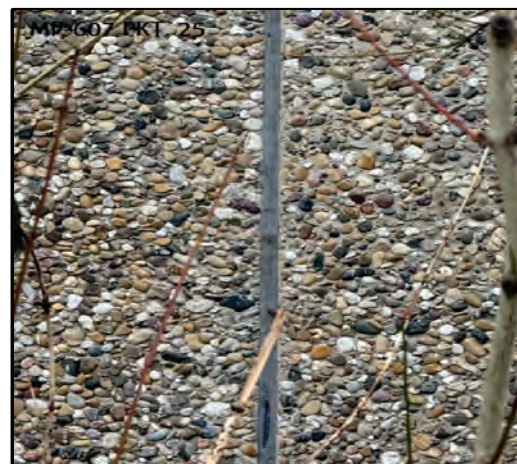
MP607-Pkt. 25, EG Anbau außen, Fugenkitt Waschbeton
